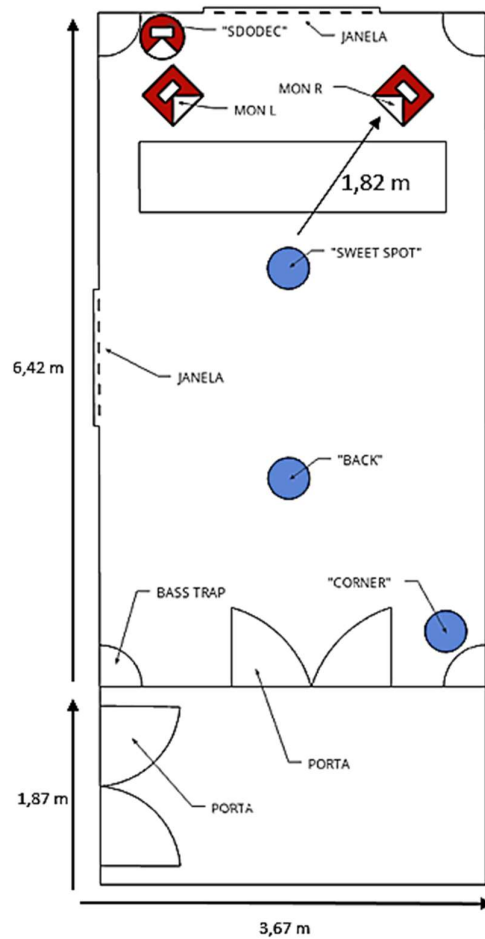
Visão planta da sala "ESMAE – Estúdio B"
